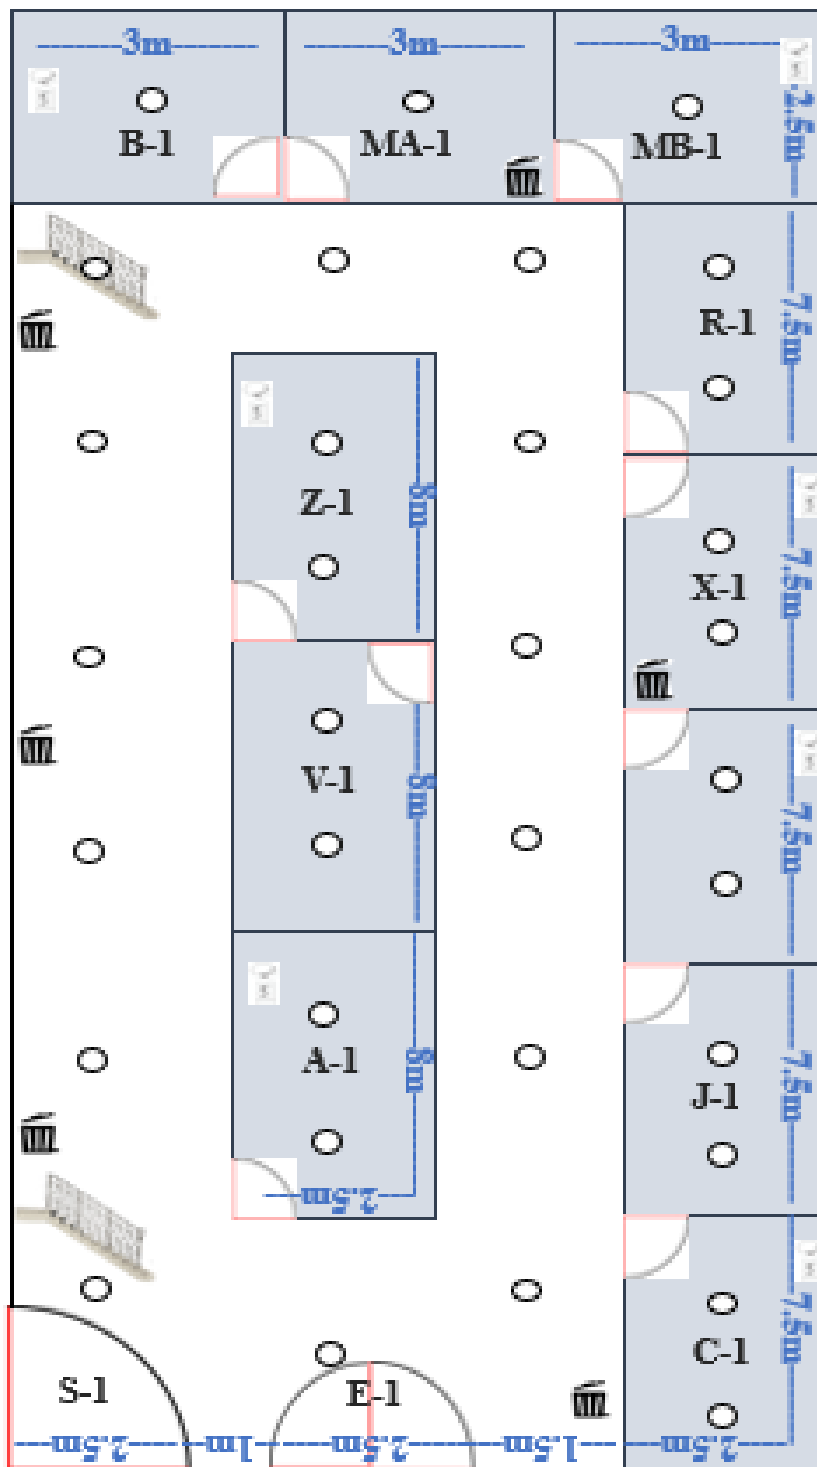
Diseño de planta BANLEMA S.A.C (PRIMER PISO)
